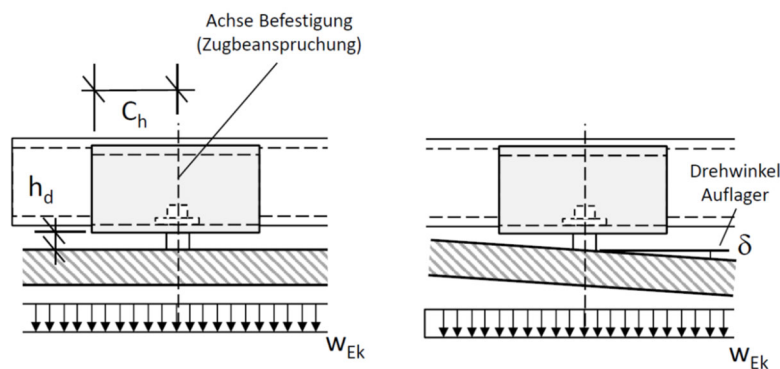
horizontale Auflagerverdrehung infolge Windbelastung
